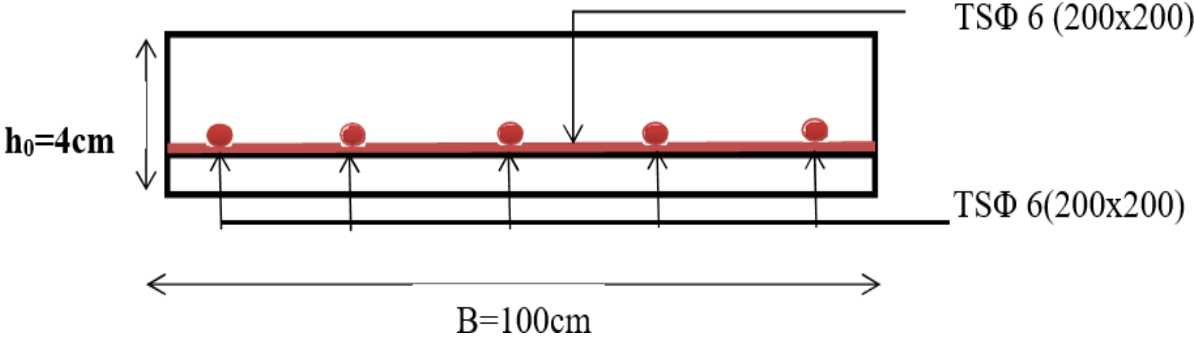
; Schéma de ferrailage de la dalle de compression.
